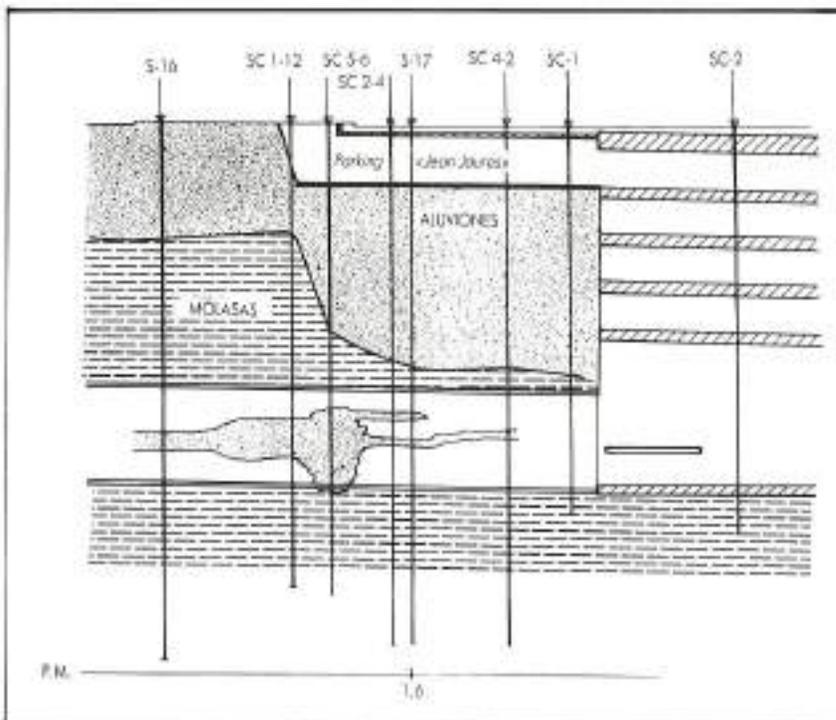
Perfil longitudinal de la legada a la estación Jean Jaures.
